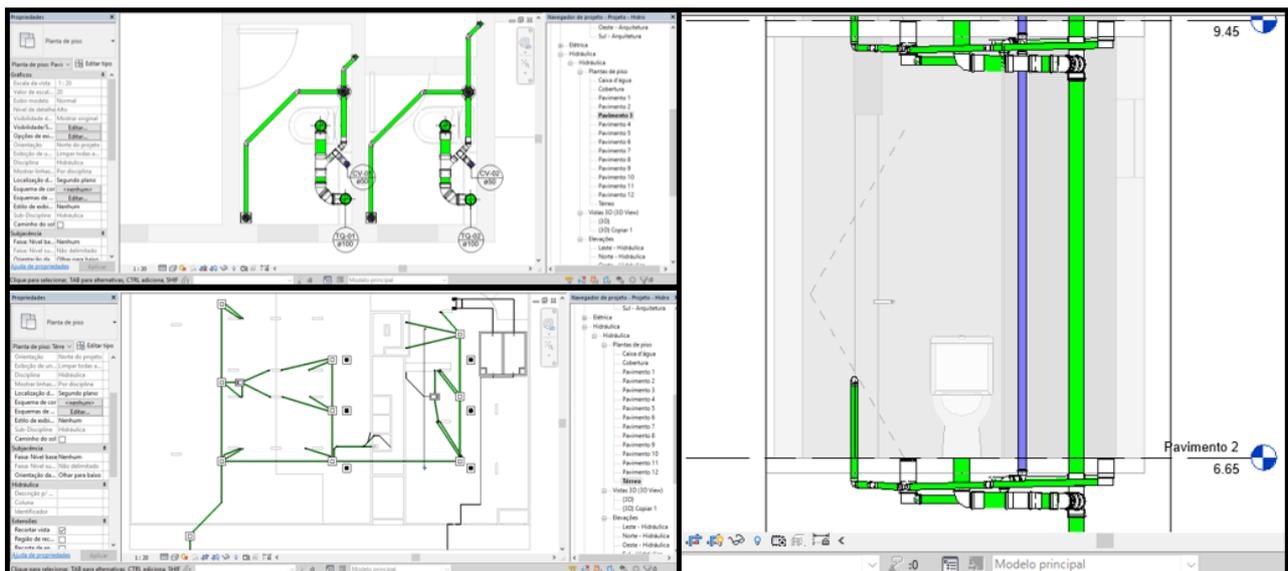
Planta baixa do pavimento 03 (banheiros) e cobertura com o lançamento das tubulações de água fria
